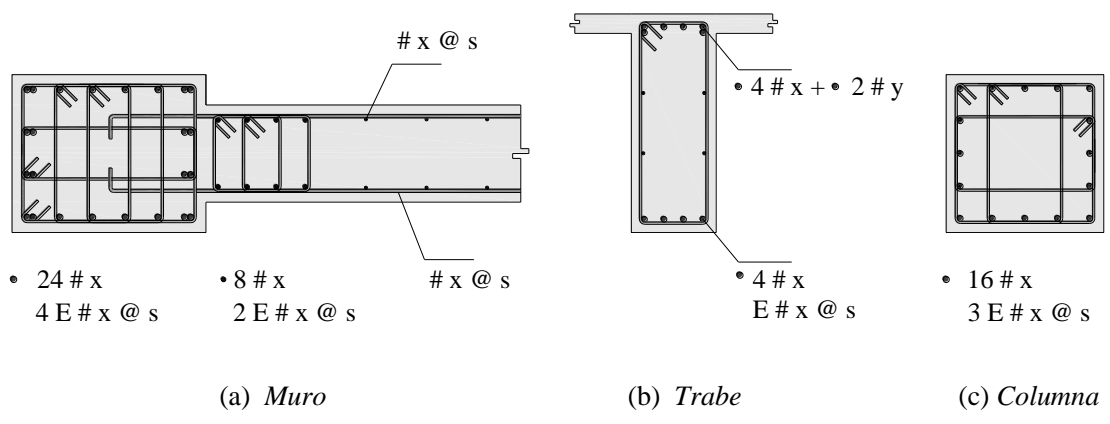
Representación esquemática del armado utilizado en los elementos estructurales
